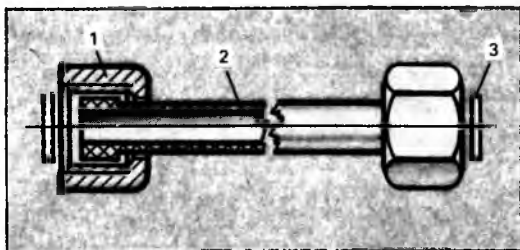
Гибкая подводка к пластмассовым и стальным трубам с резьбой 1/2В: 1 — накидная гайка, 2 — полиэтиленовая трубка, 3 — резиновая прокладка
